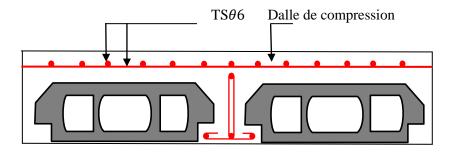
Schéma de ferraillage de la dalle de compression.
